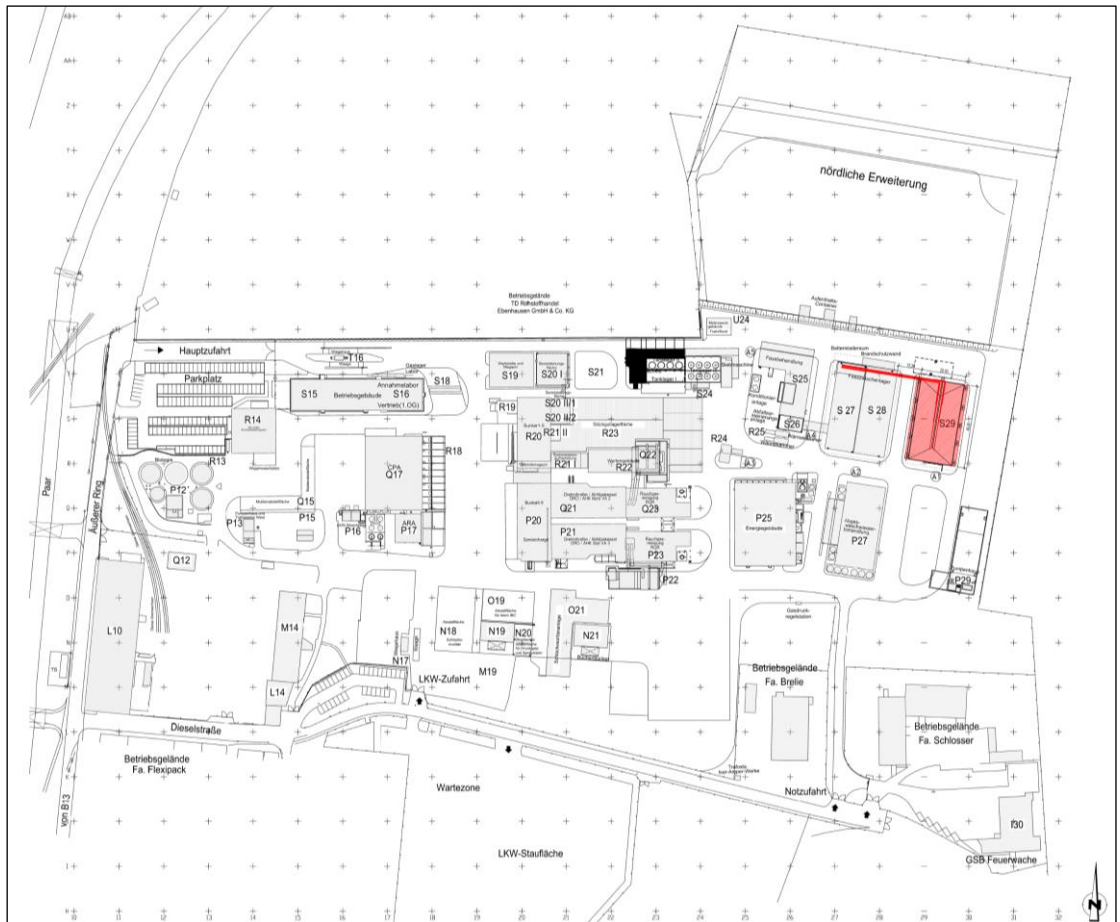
Lageplan der geplanten Stückgutabstellfläche S29 (Quelle: IA-Tech GmbH)
